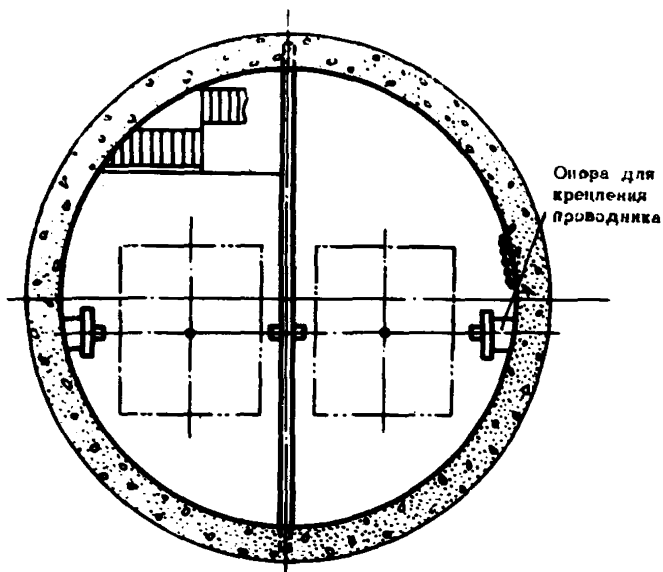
Комбинированная схема конструкции армировки с обычными и консольными расстрелами и регулируемым креплением проводников
